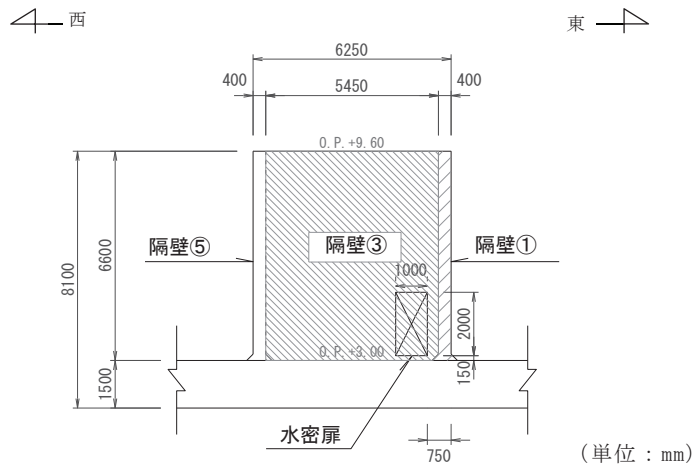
(3) 補機ポンプエリア断面図 (③—③断面)
